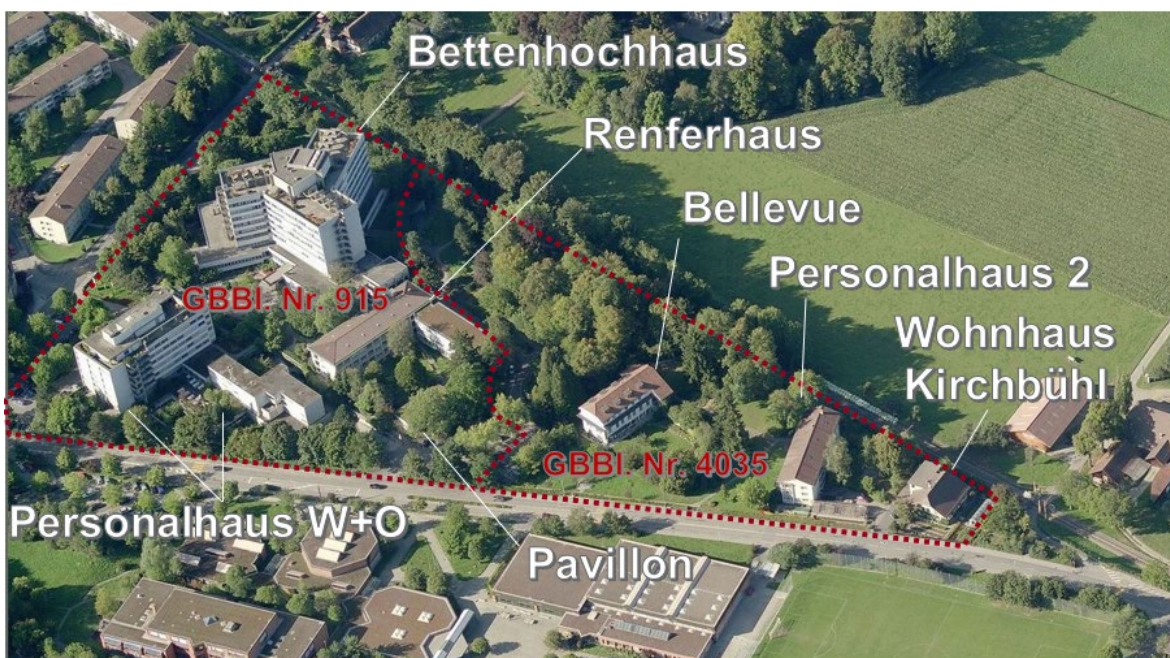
Situationsplan mit Bestandsbauten, Google-Maps 3D, Jan. 2021
